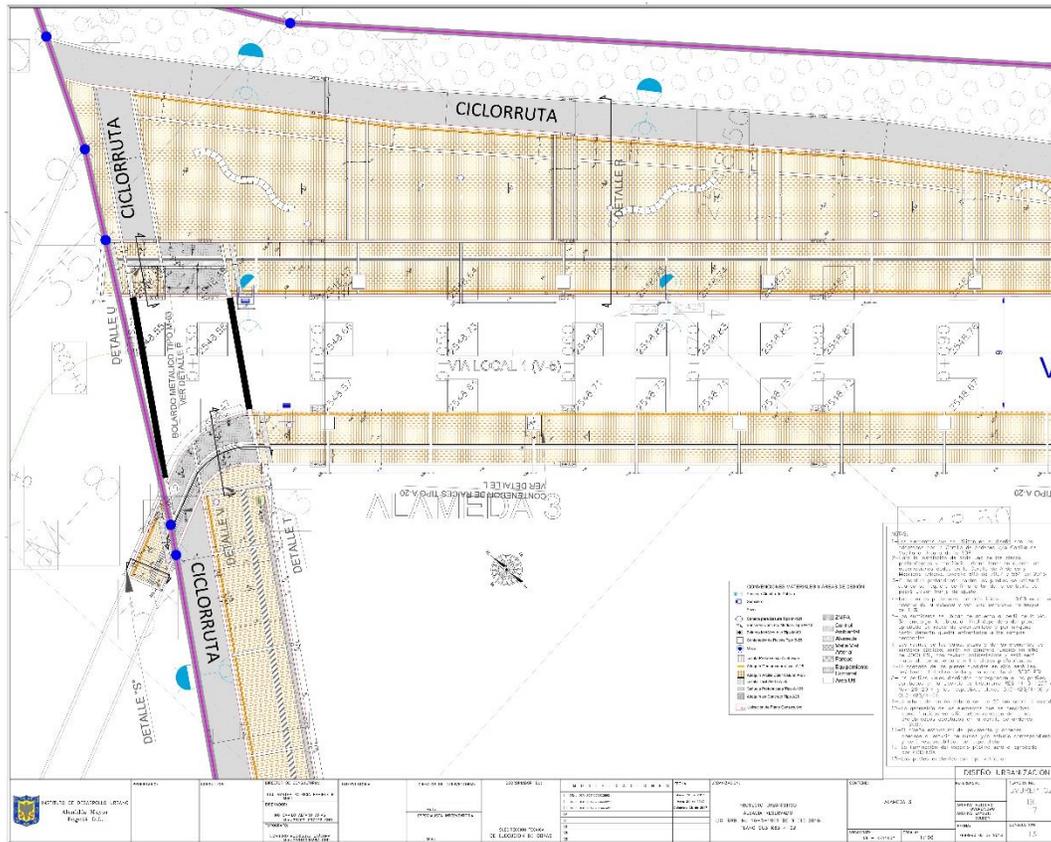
Plano de corte arquitectónico del proyecto La Ribera Alsacia
